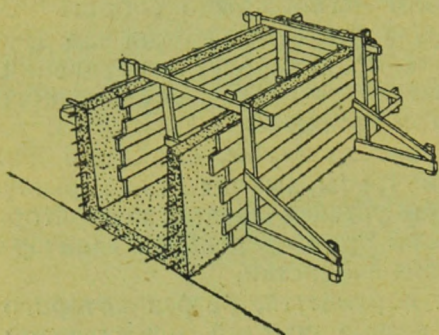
Опалубка надземного септика. Помимо горизонтальной арматуры, изображенной на этом рисунке, имеется также и вертикальная арматура, но прутья последней расставлены реже.
